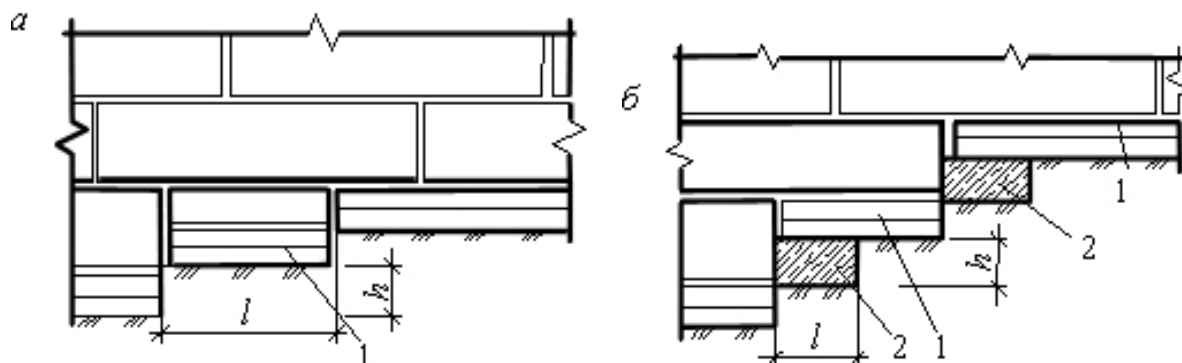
Переход фундамента от одной отметки заложения к другой: *а* – сборных; *б* – с использованием монолитного бетона; 1 – фундаментные плиты; 2 – бетон по месту
